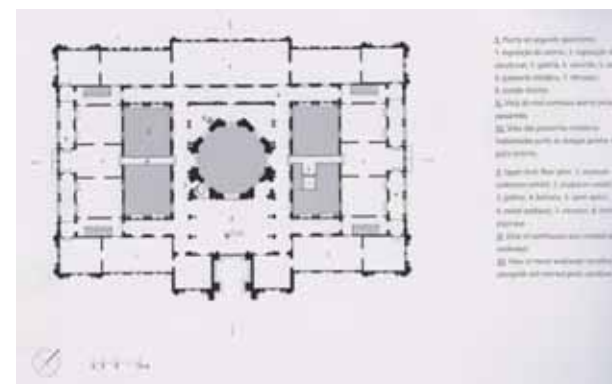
Planta Segundo Pavimento (Fonte: ARTIGAS, 2000)
